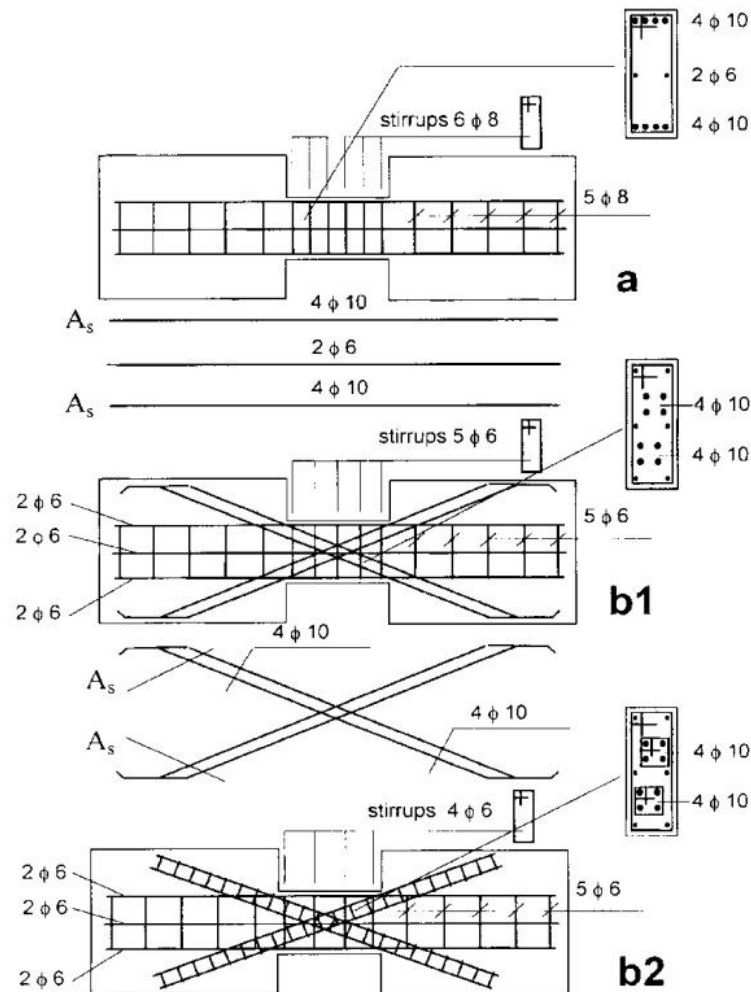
Ejemplos de armado de refuerzo de vigas de acople [13]
